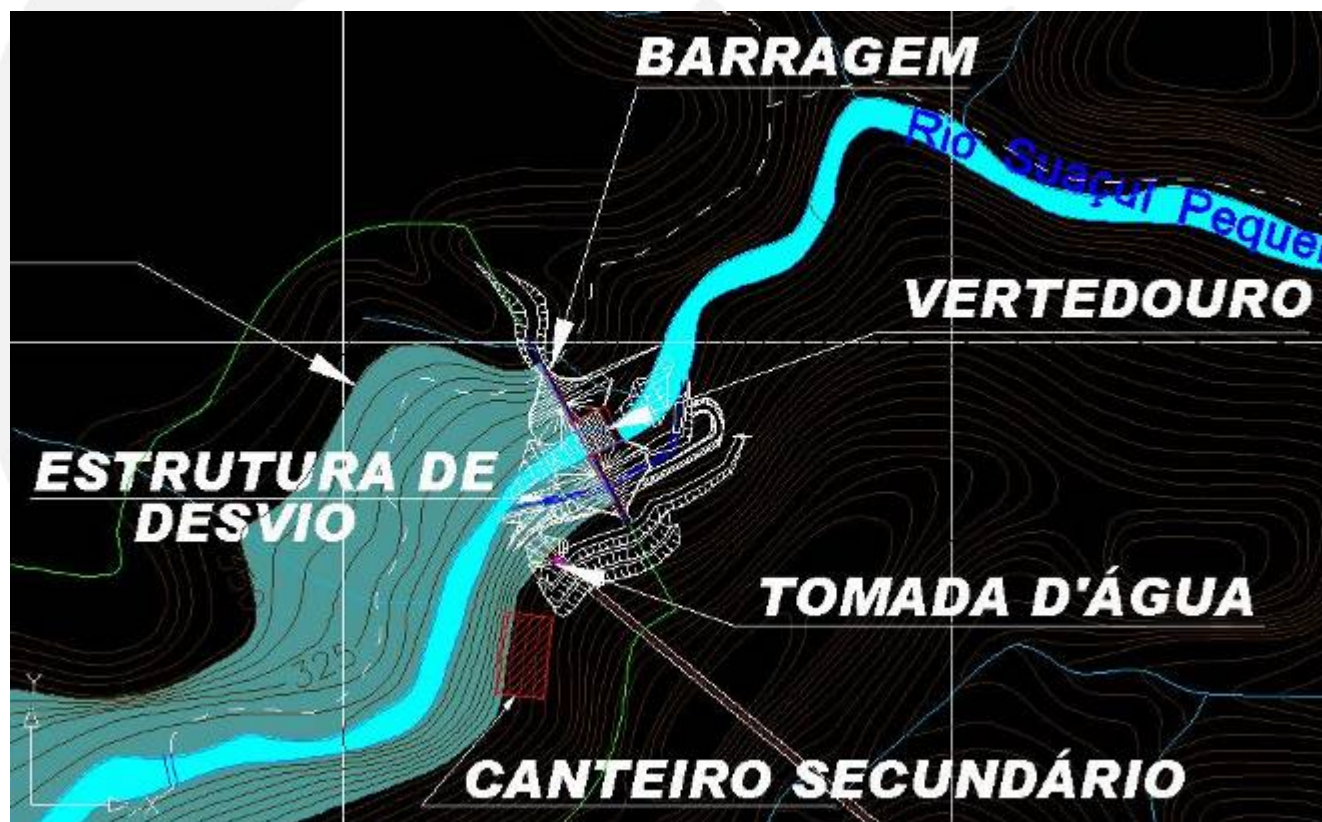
Arranjo das Instalações – Detalhe no Eixo da Barragem – Créditos WALM.
